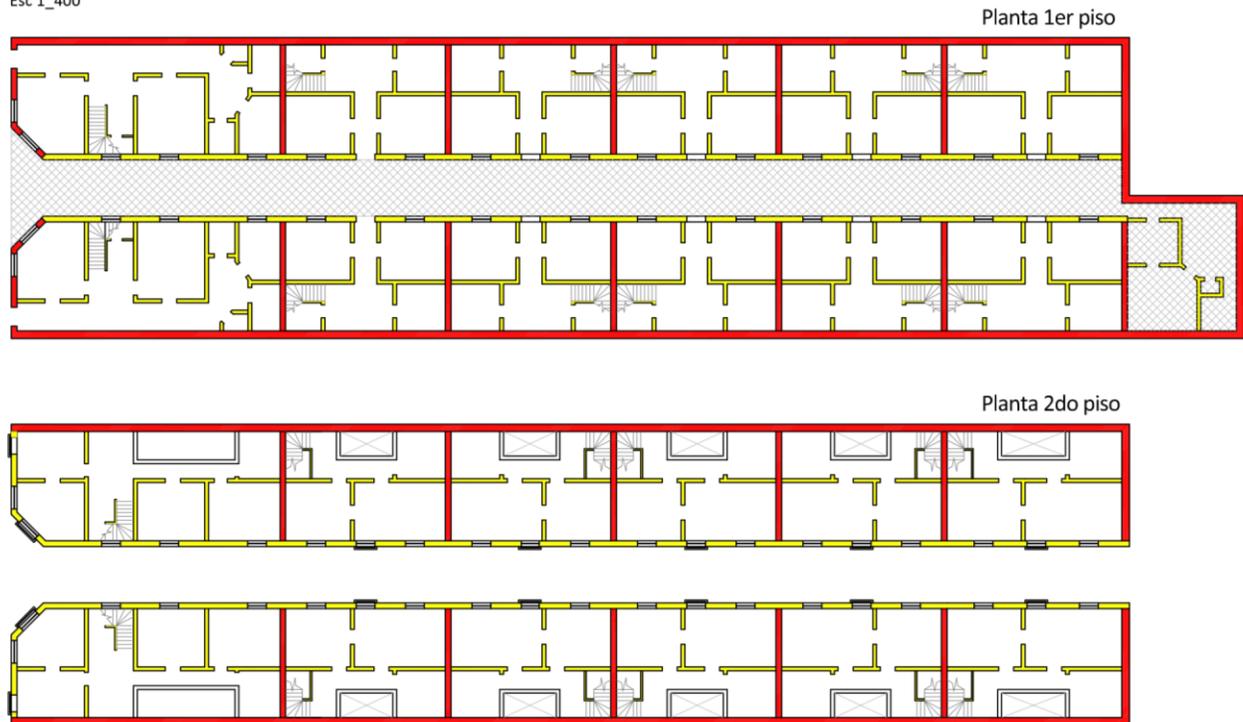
Planta Sistema Constructivo. ROJO: Albañilería \_ AMARILLO: Tabiquería
